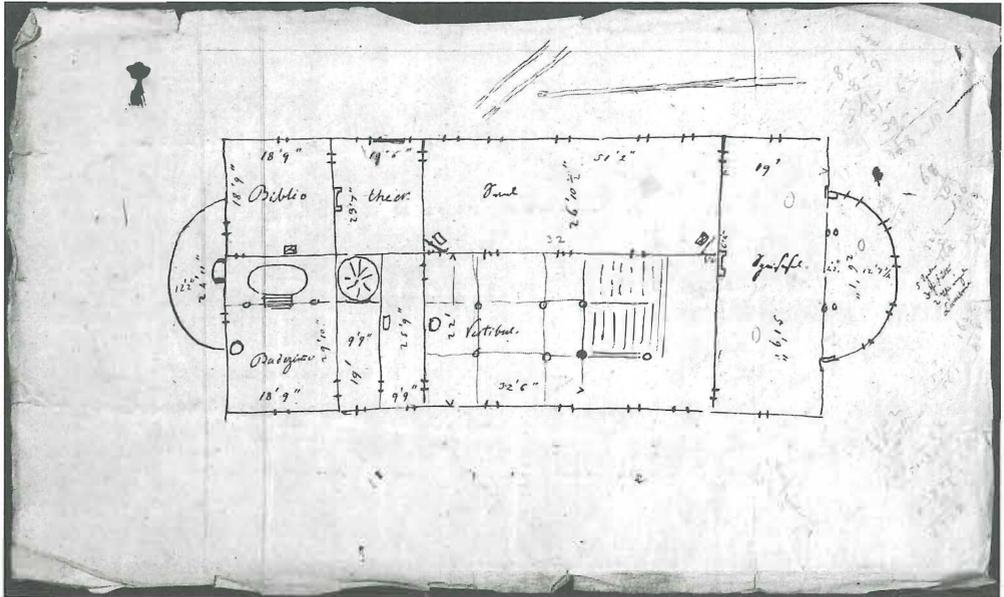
Schloss Wilhelmshöhe, Weissensteinflügel, Grundriss-Skizze, Erdgeschoss, um 1825.
